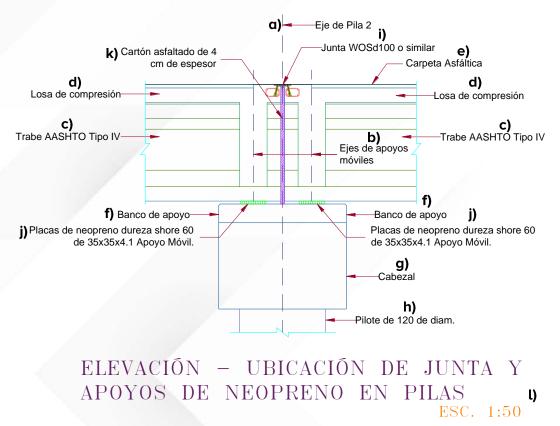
Ejemplo de elevación, ubicación de junta y apoyos de neopreno en pilas
